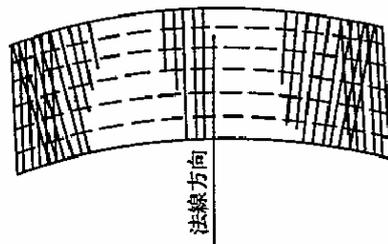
主鉄筋の配筋方向 (支承線が法線方向と異なる曲線橋の場合)
